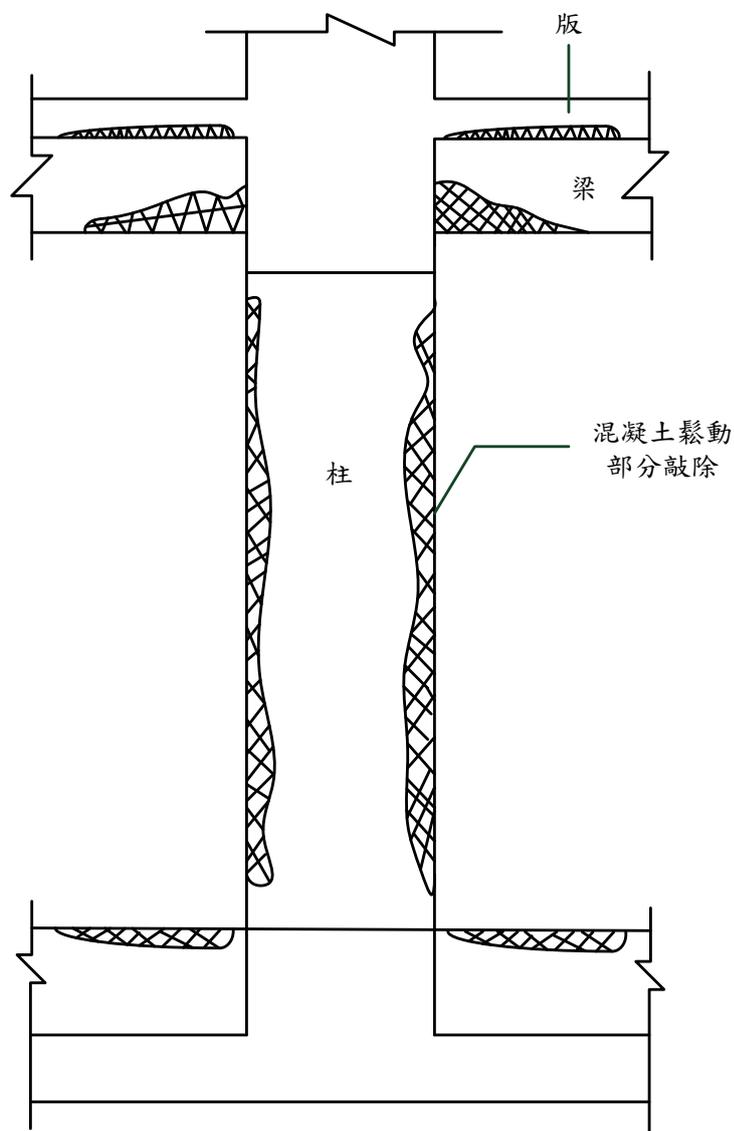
鋼筋生鏽、混凝土開裂修補工法示意圖
